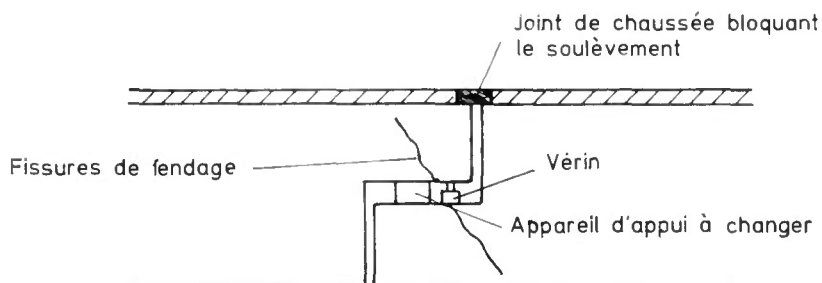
Exemple de dispositif antisoulèvement générateur de désordres.
